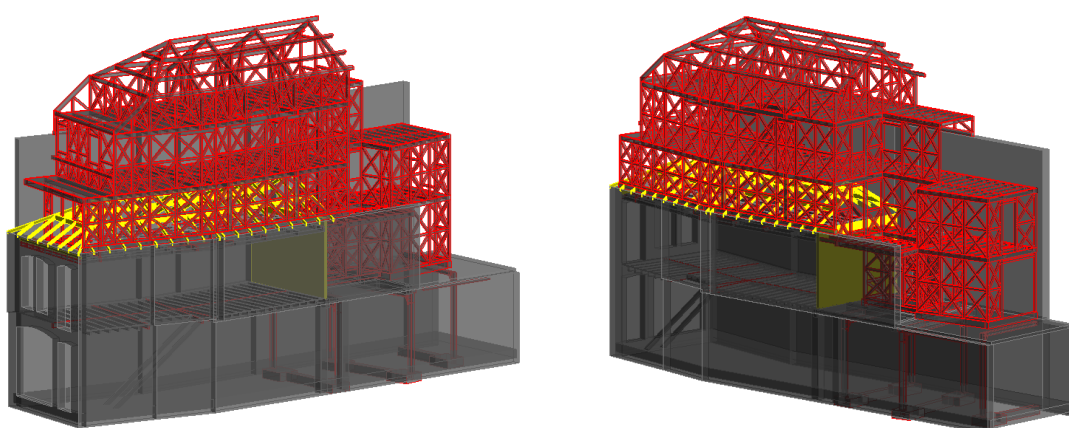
Sobreposição dos elementos existentes, elementos a contruir e a demolir (“Vermelhos e amarelos”).
